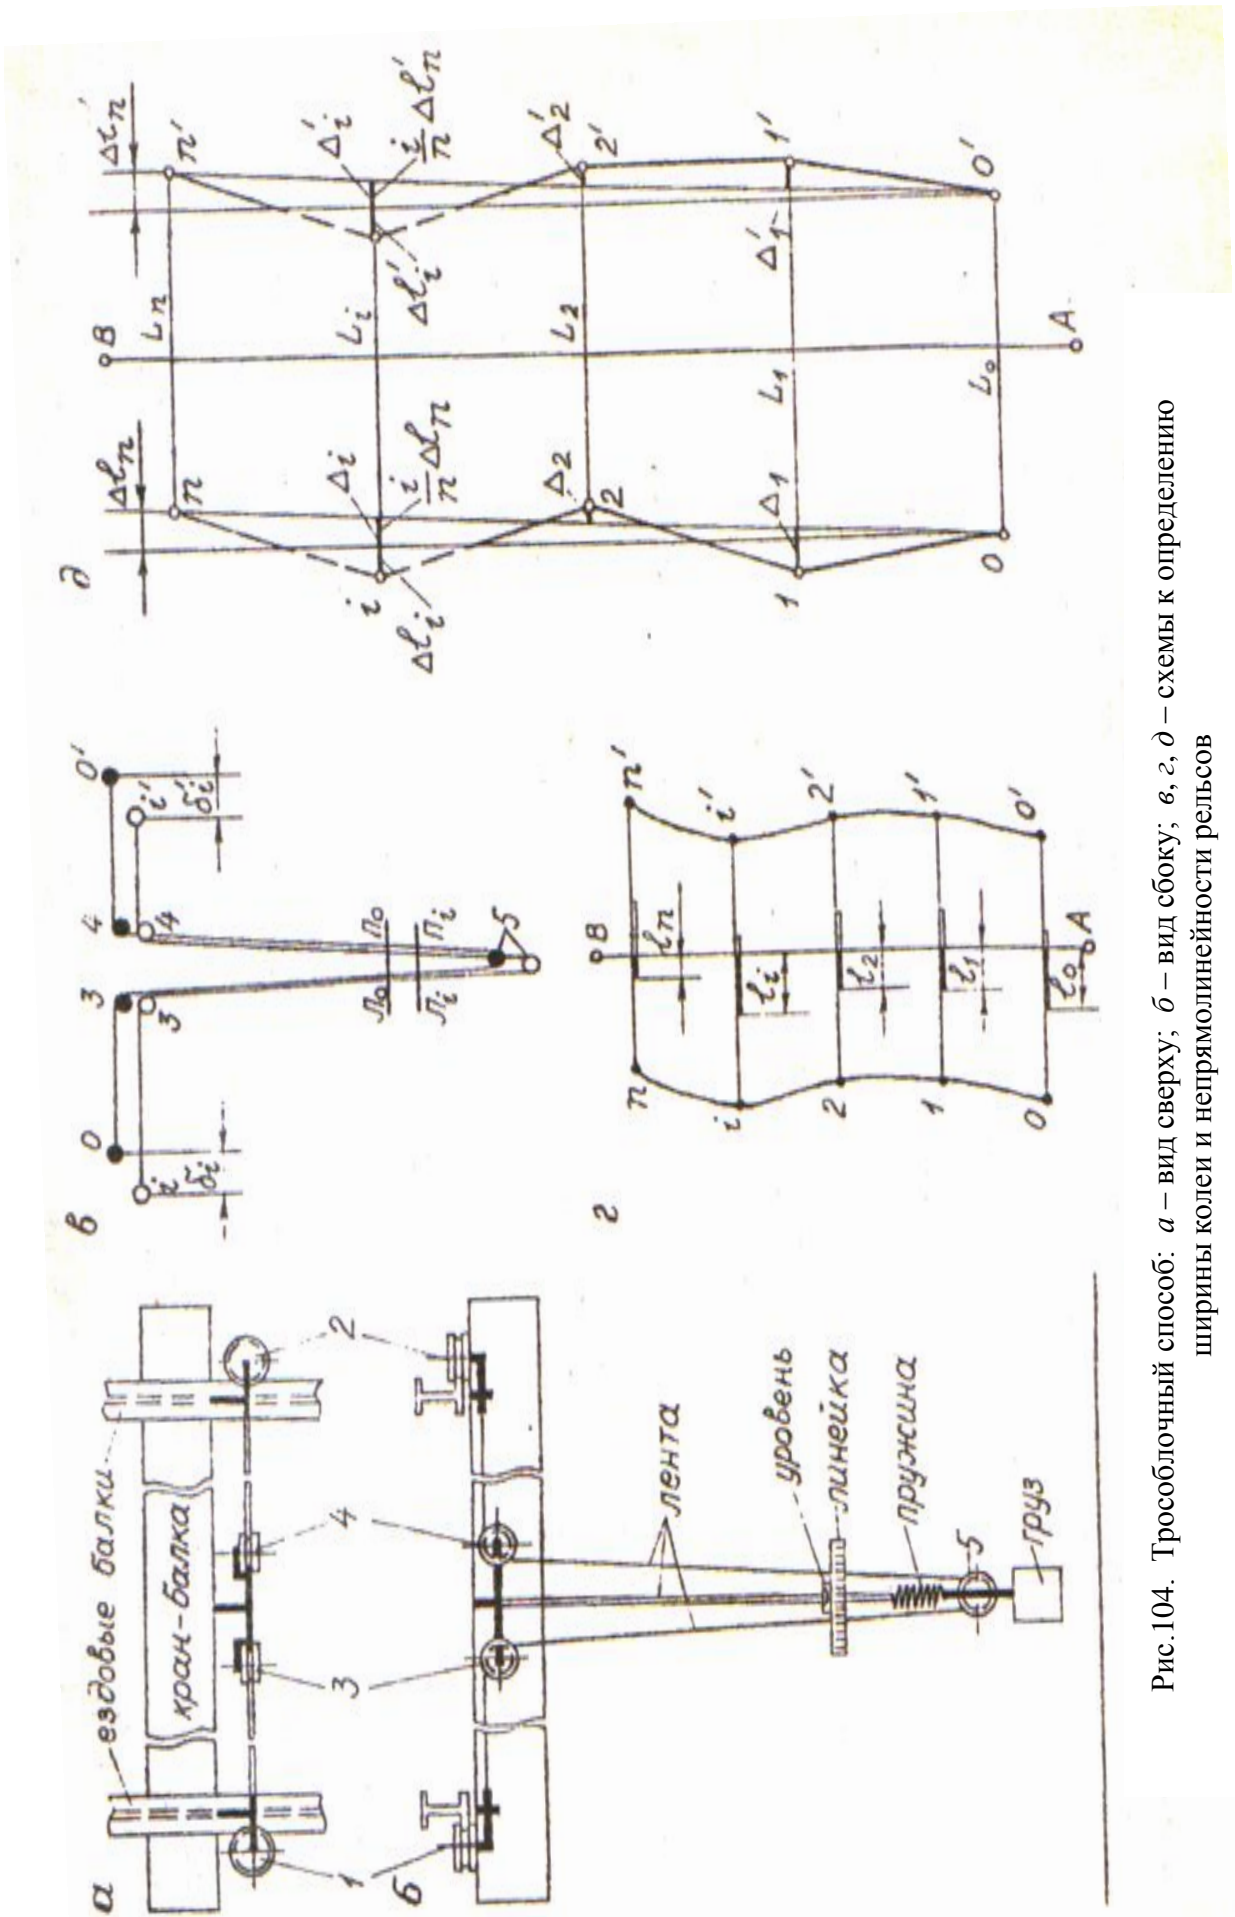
Трособлочный способ: а – вид сверху; б – вид сбоку; в, г, д – схемы к определению ширины колеи и непрямолинейности рельсов
